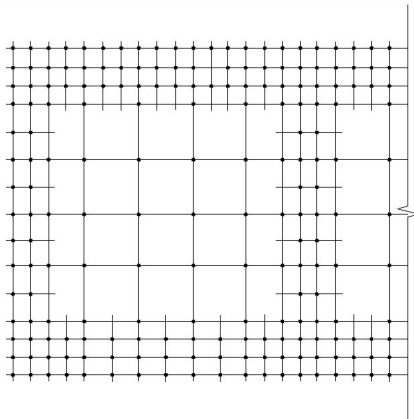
模板支架不同立杆间距布置平面示意图
